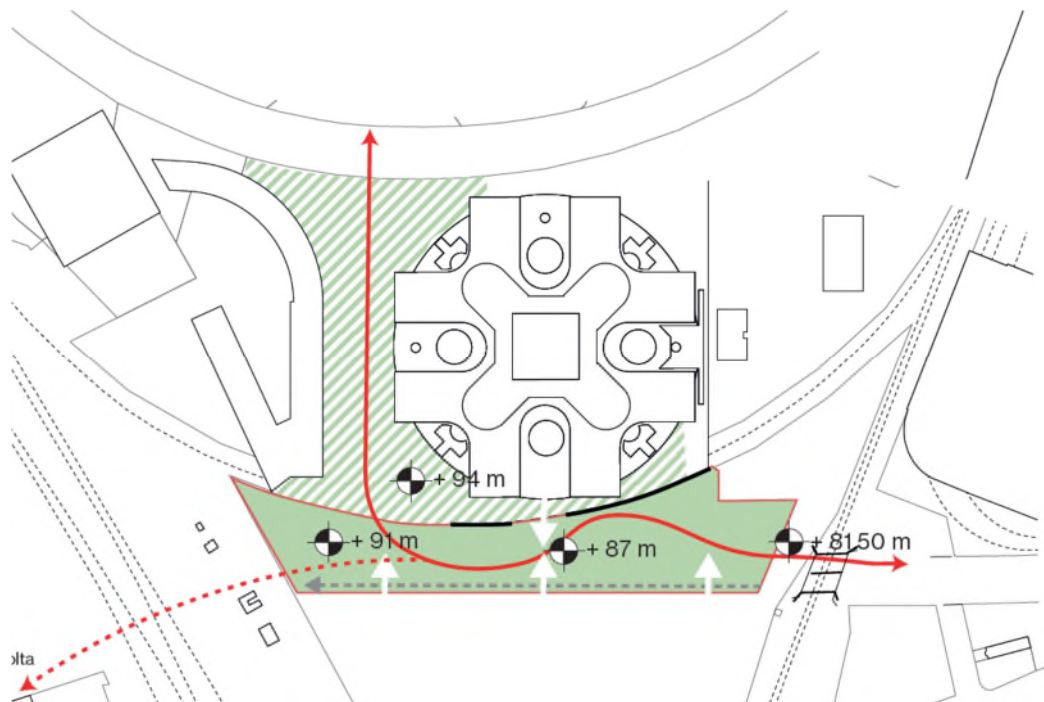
Plan du parkway sur le site Triangle (ORG, 2018)
